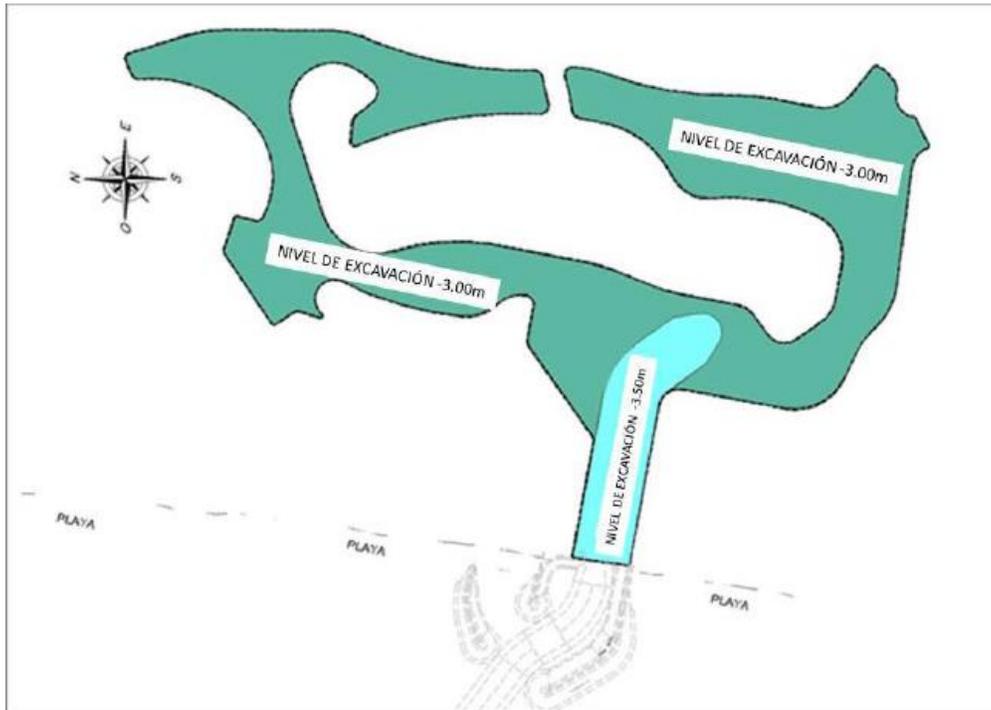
PLANO GENERAL DE LA EXCAVACIÓN Y DRAGADOS DE LA MARINA
